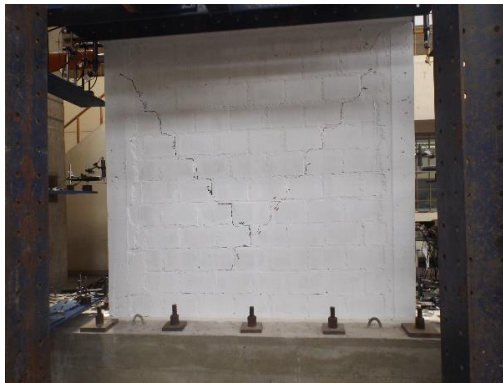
Formación de grietas diagonales en el mortero hasta la parte central del muro para una distorsión 1/1100 Vista cara Sur
